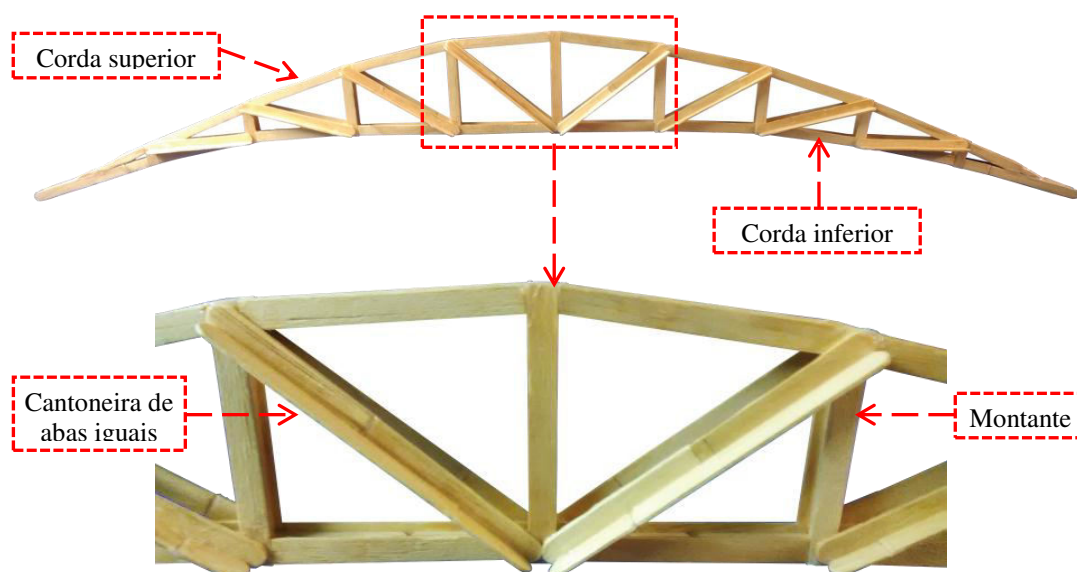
Modelo da treliça a 10 m de vão fabricado em madeira.
